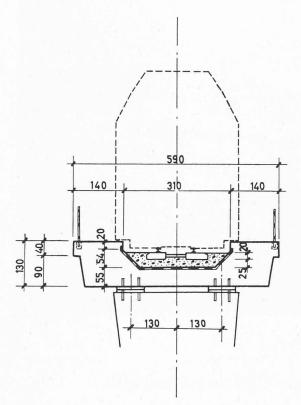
Coupe en travers sur la section rectiligne de l'ouvrage.
